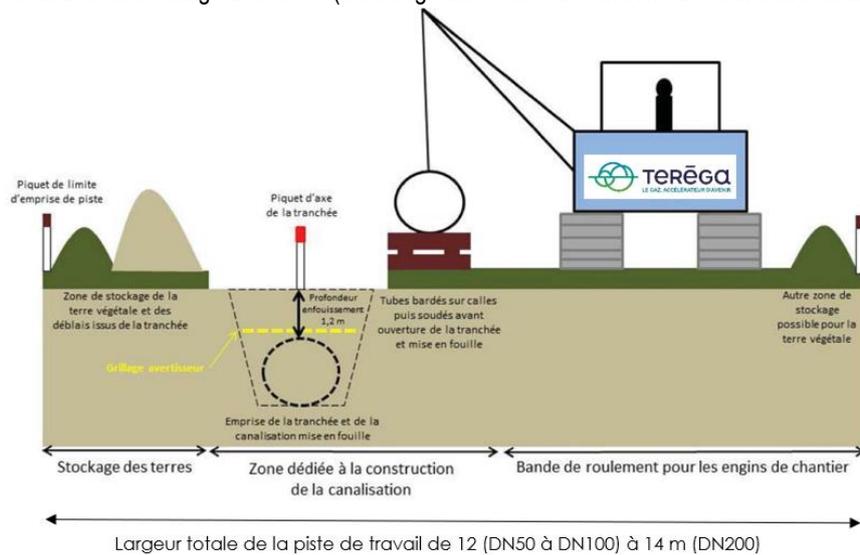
emprise de la piste de chantier (Source : TEREGA)
